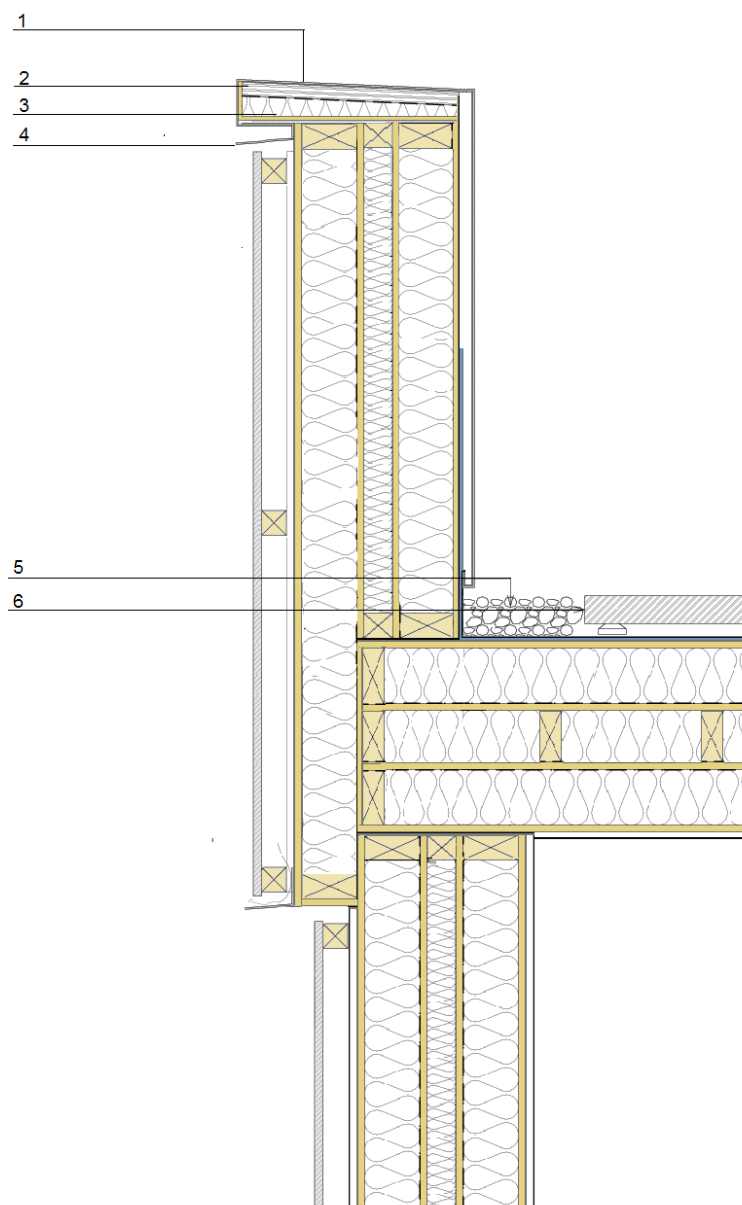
Утеплення парапетів, влаштування перекриття і покрівлі
